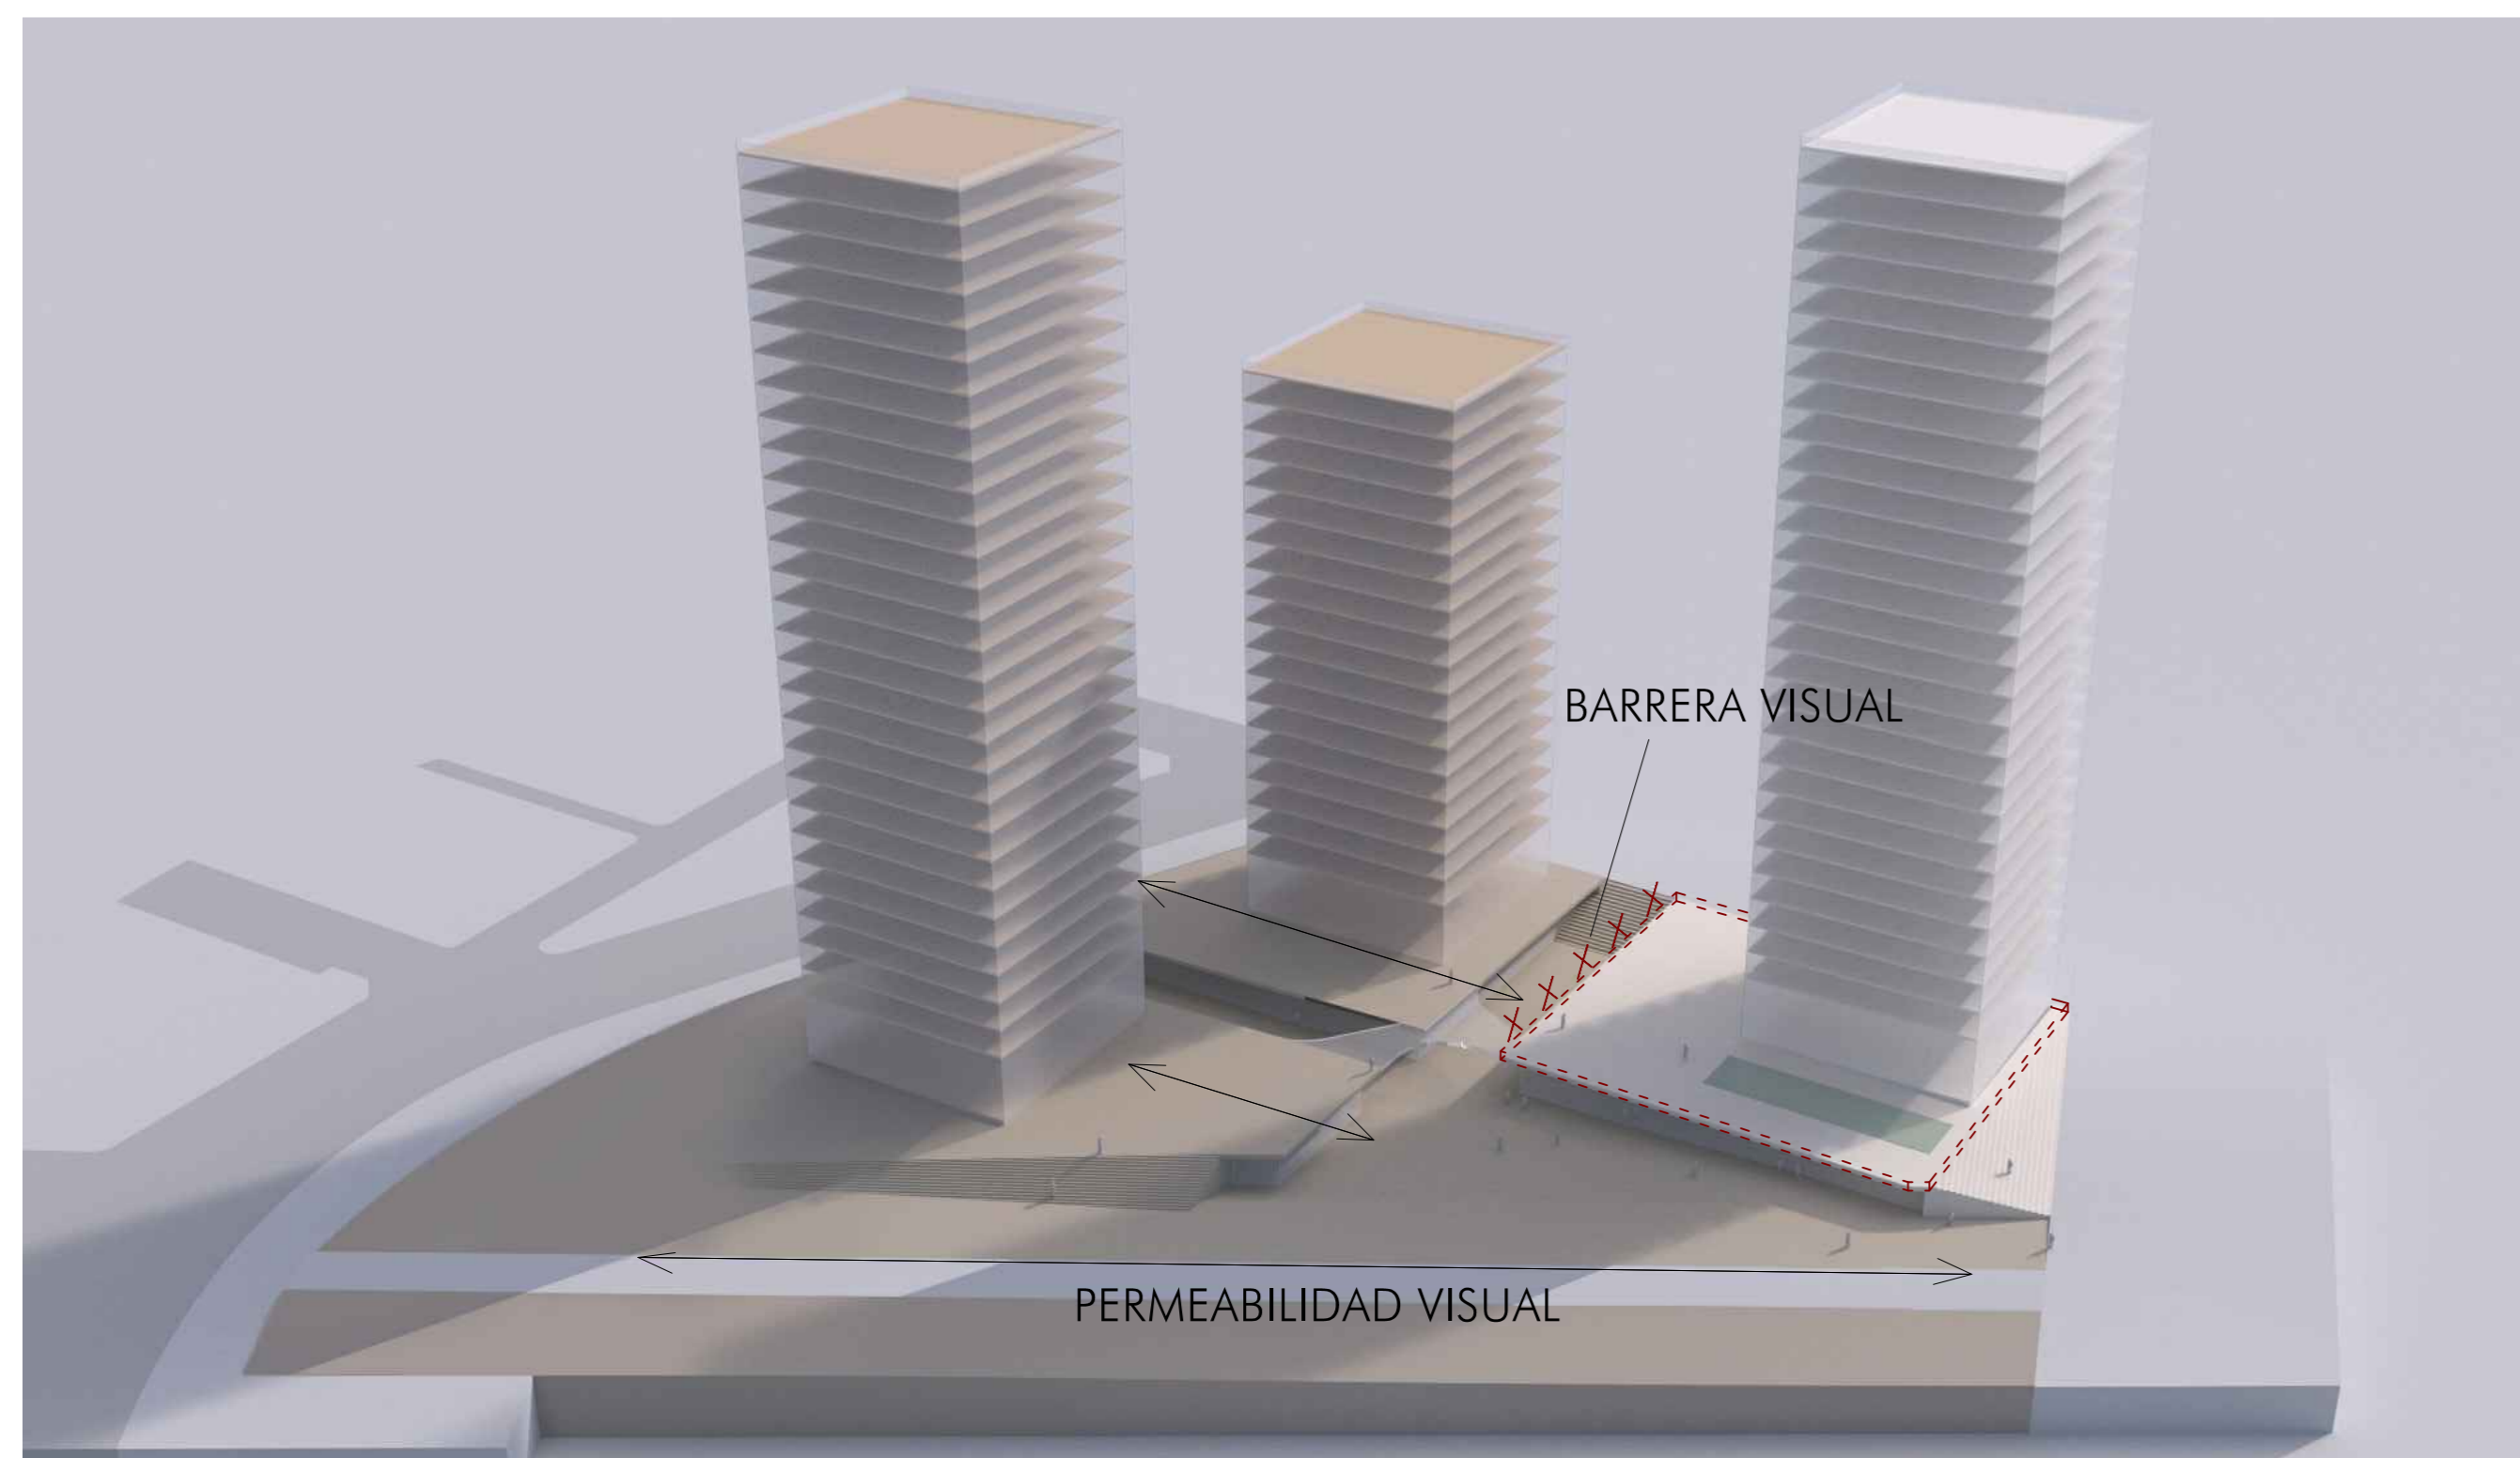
IMAGEN DE LA PROPUESTA. VOLUMETRÍA
